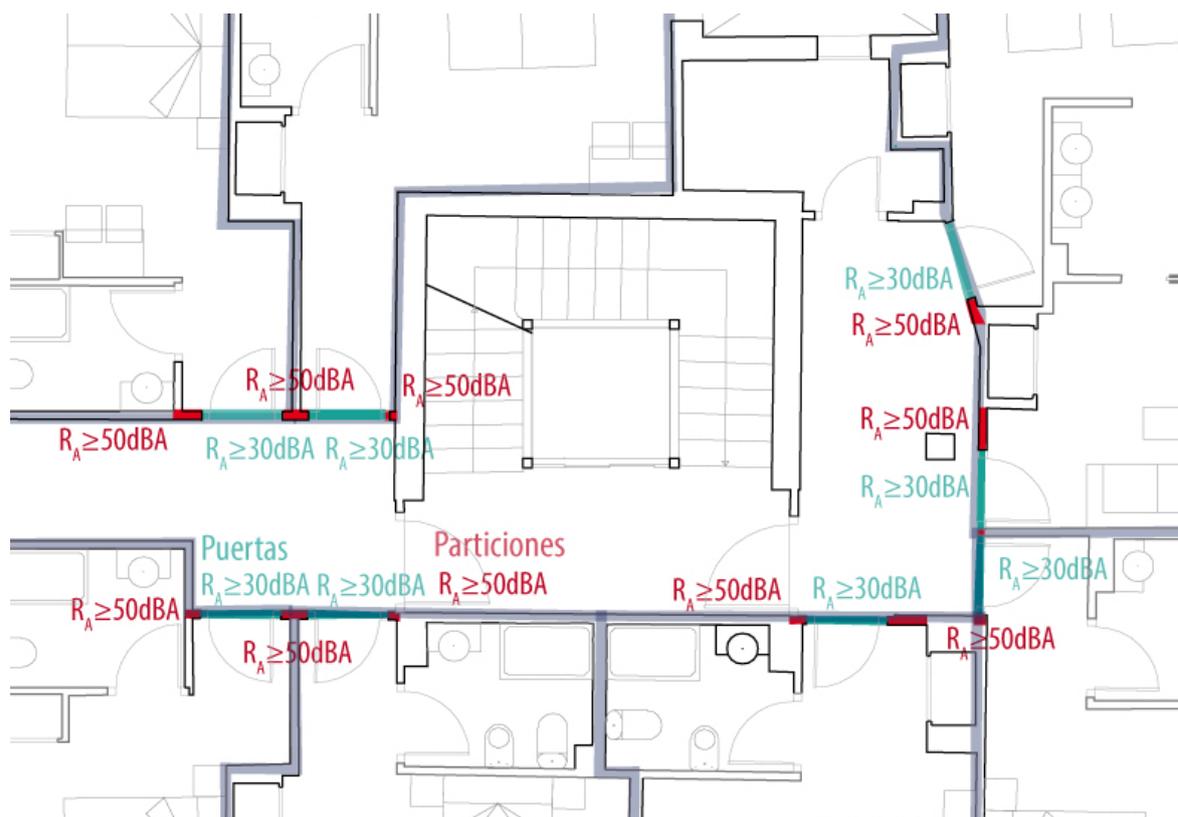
Detalle planta tipo. Valores de aislamiento a ruido aéreo exigidos a los elementos de separación verticales con puertas.
